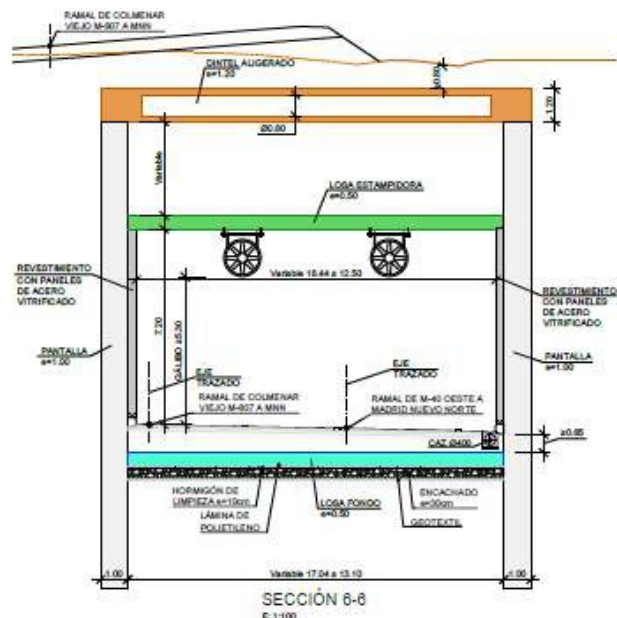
Sección tipo con losa de fondo de 0.50 m, estampidor intermedio y dintel aligerado de 1.20 m. Falso túnel Norte
